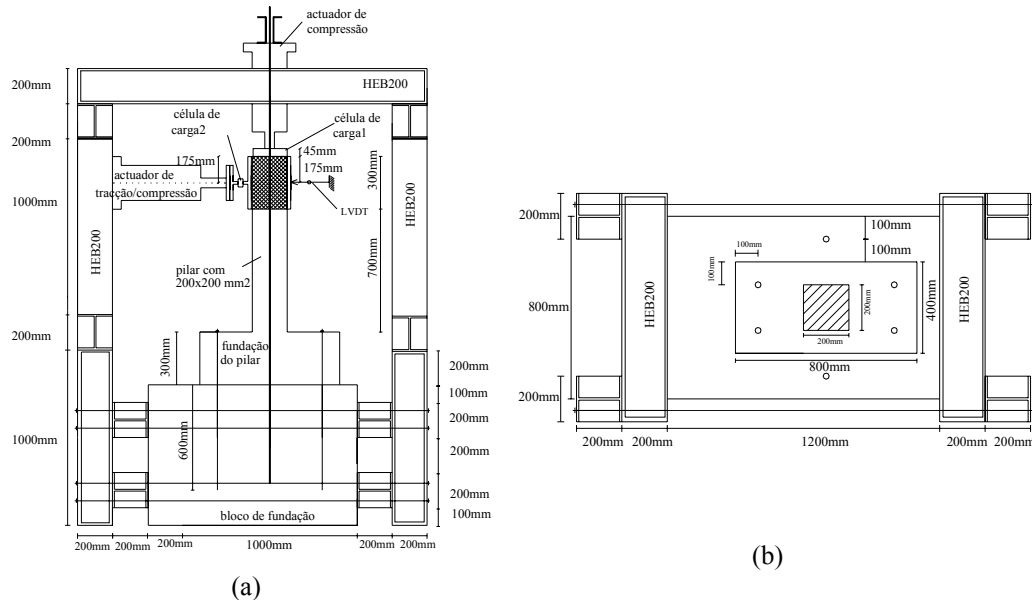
Esquema do sistema de ensaio: a) vista lateral, b) Vista em planta.
